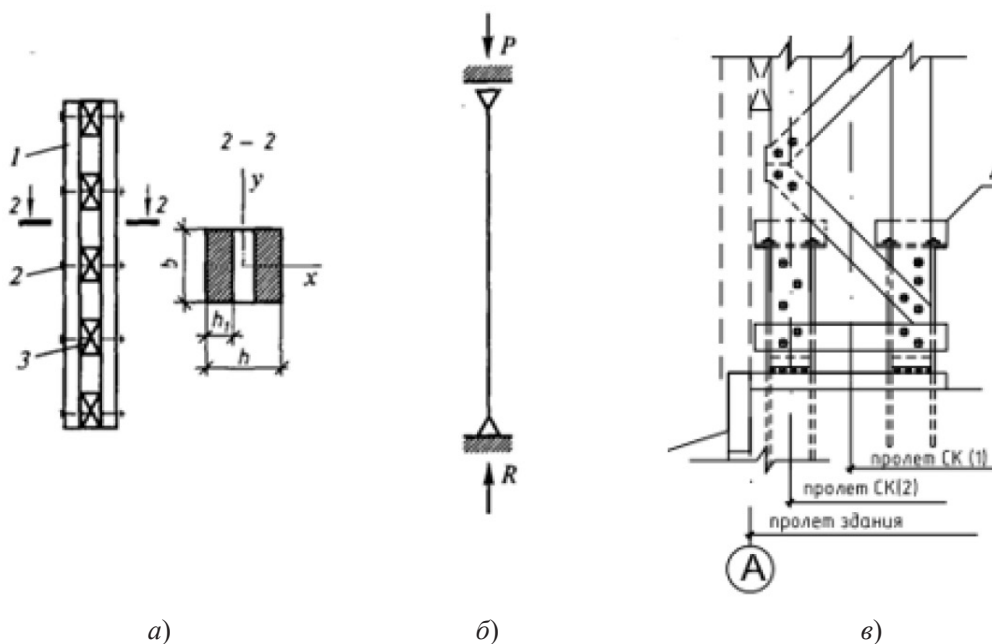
Схема составной колонны: а – составная колонна со сквозными прокладками; б – схема работы; в – схема соединения элементов конструкции; 1 – брус; 2 – болты; 3 – прокладки; 4 – воротниковая накладка из металлических уголков
